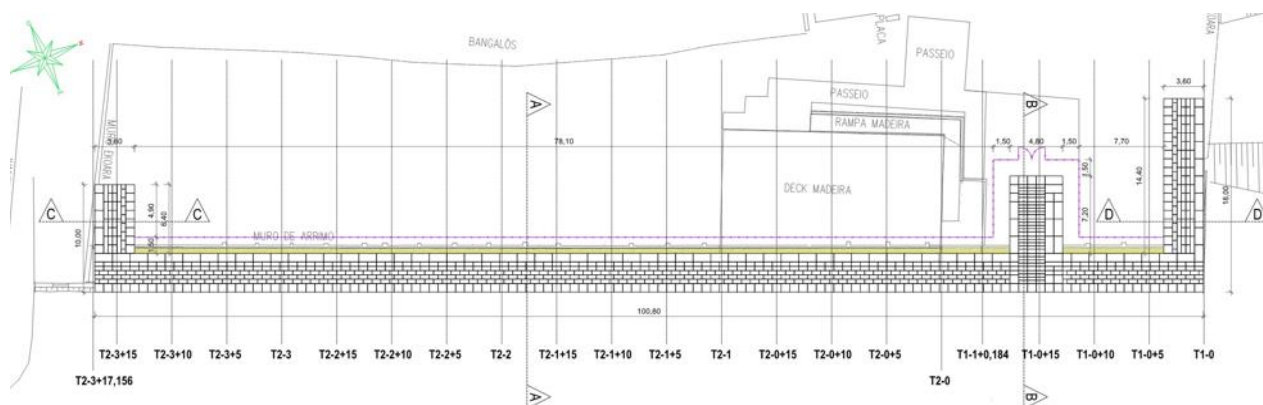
Planta baixa – projeto executivo contenção marítima em BetonBlo, Ipojuca/PE
